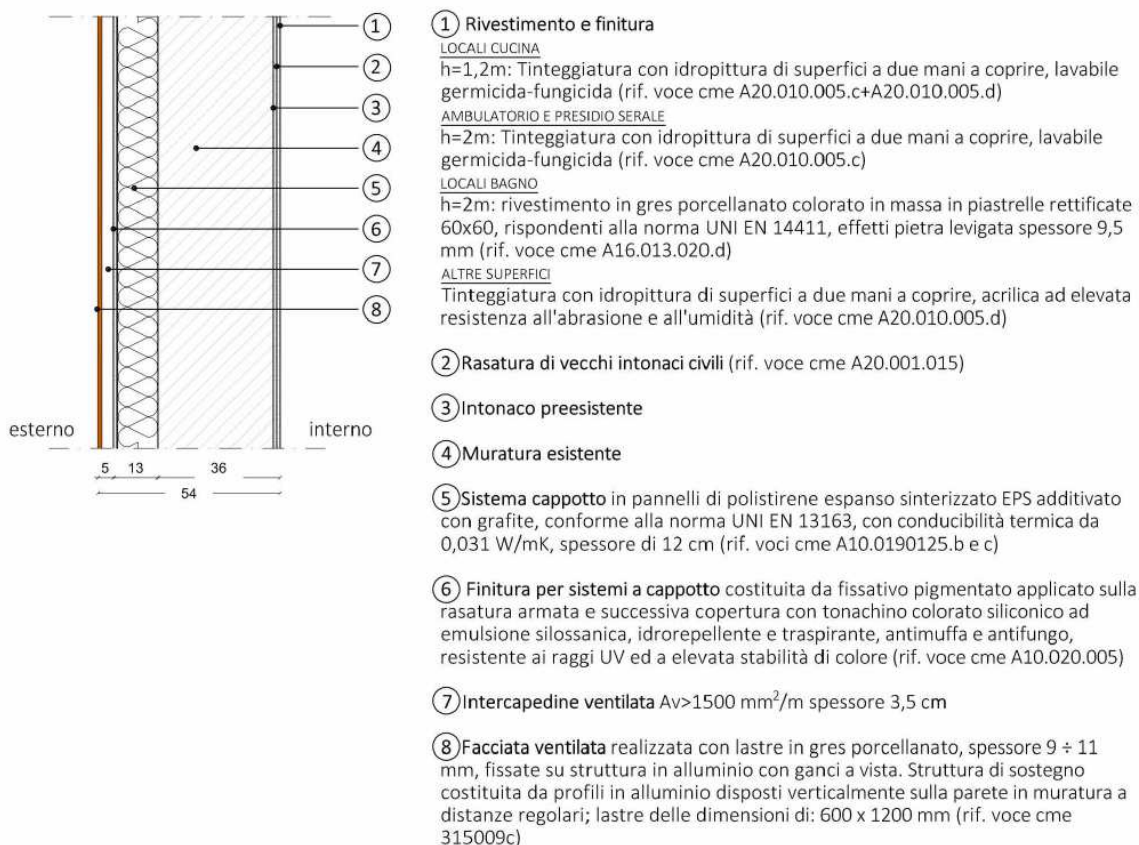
dal progetto architettonico: stratigrafia del muro esterno con cappotto e ventilazione
